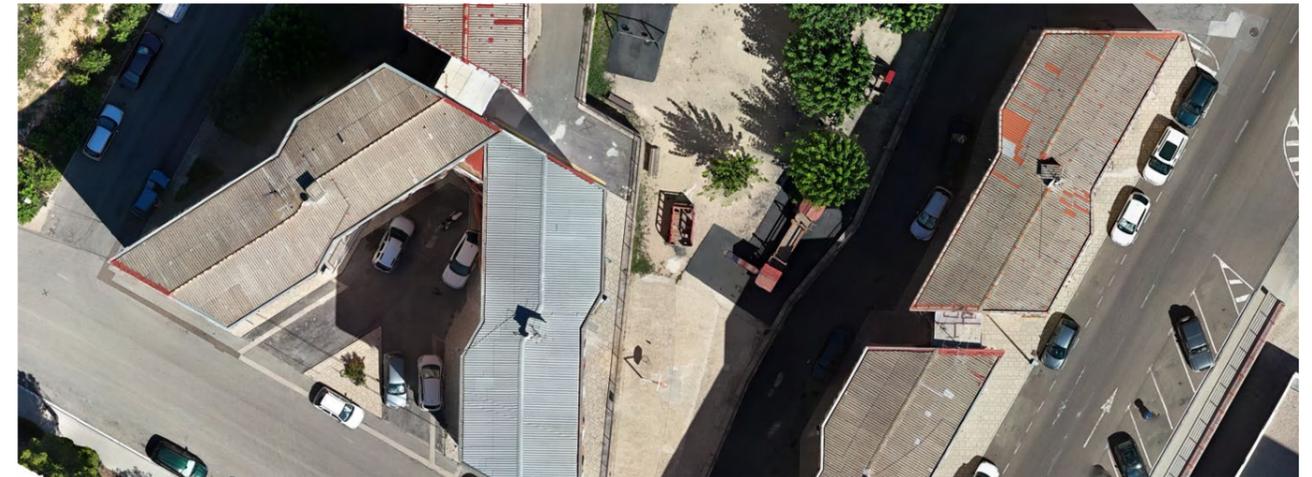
Ortofoto cubiertas barrio Font Dolça.
